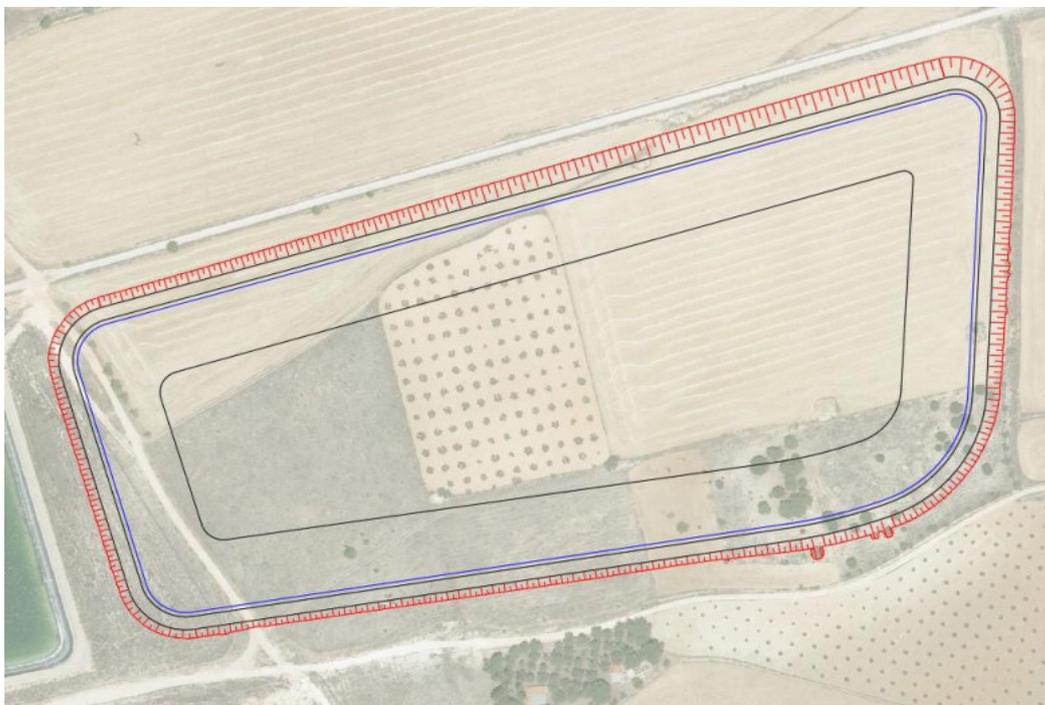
Vista en planta de la balsa de la alternativa 1. Fuente: Elaboración propia a partir de PNOA © cedido por IGN.
